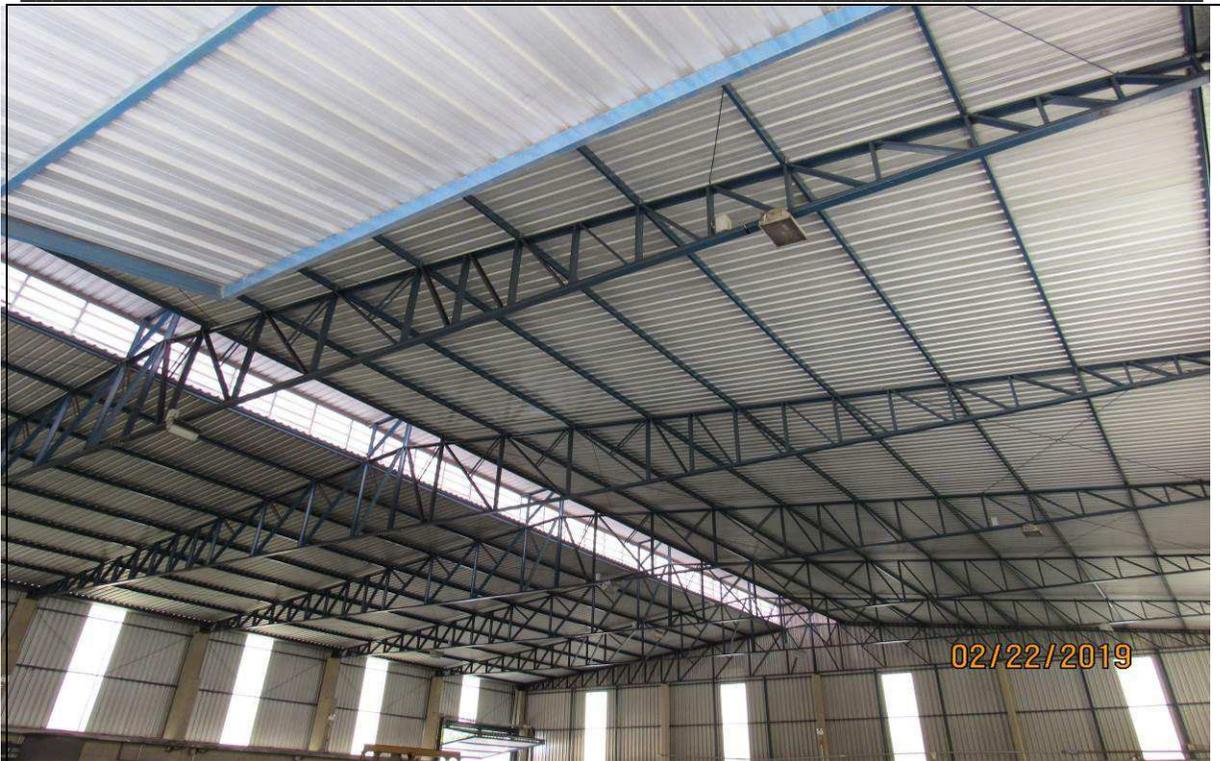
Vista geral da estrutura metálica e cobertura do galpão industrial.
